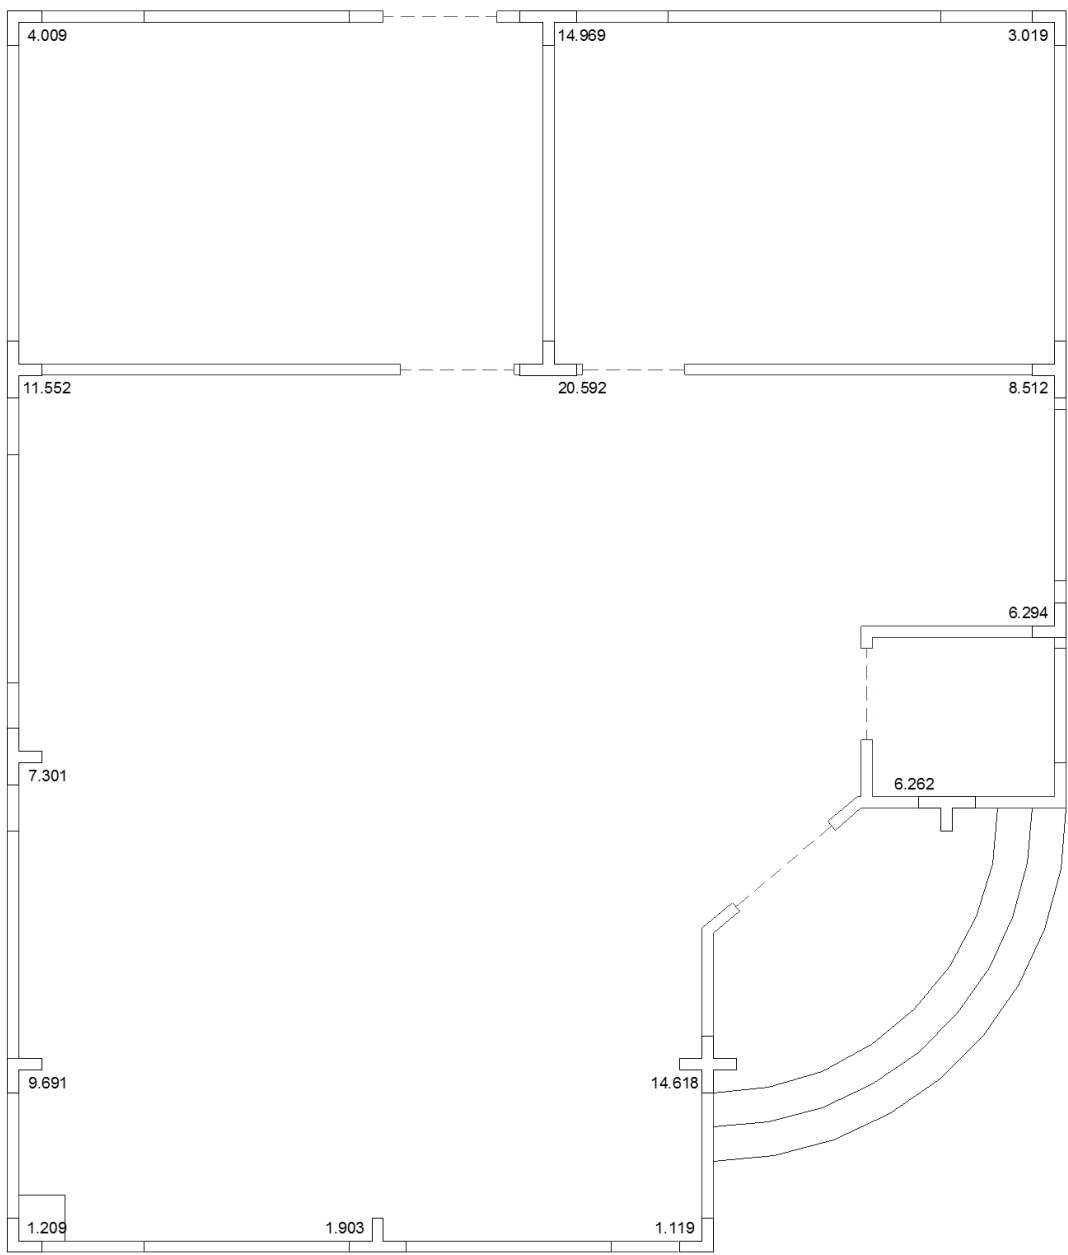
Flujo de cargas en seudo columnas en losa N+2.70m
